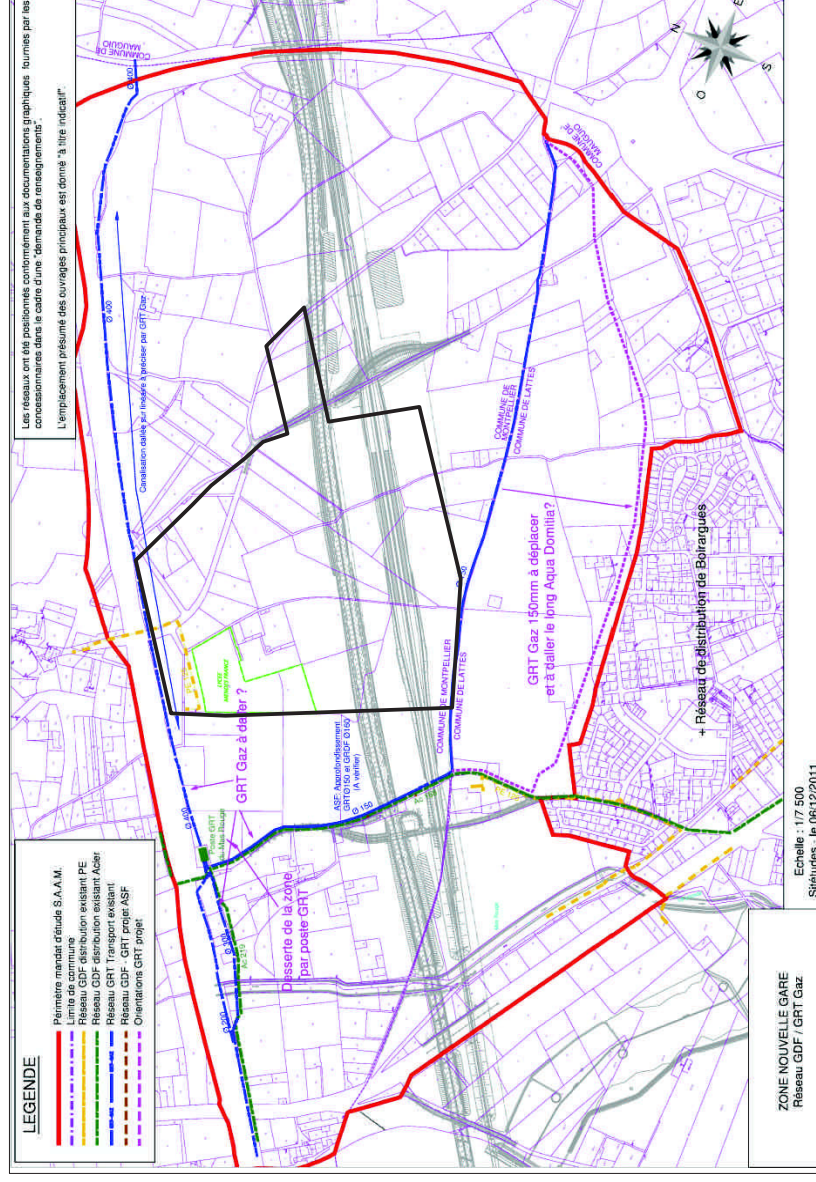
Plan des réseaux de gaz sur la zone d'étude
